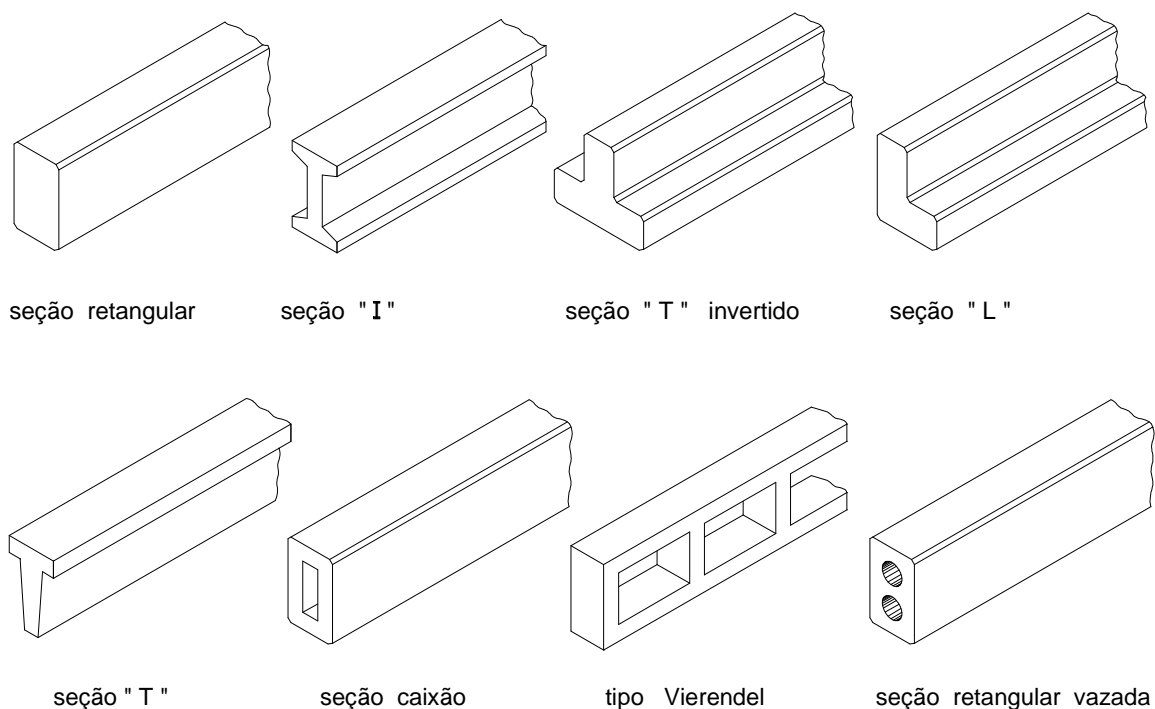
Seções transversais utilizadas em vigas pré-moldadas (Fonte: EL DEBS (2000))
